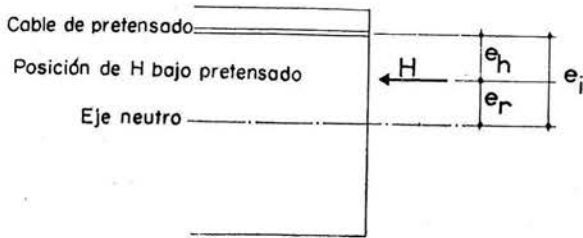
Efecto del pretensado solamente, en una sección de viga de un sistema hiperestático.
